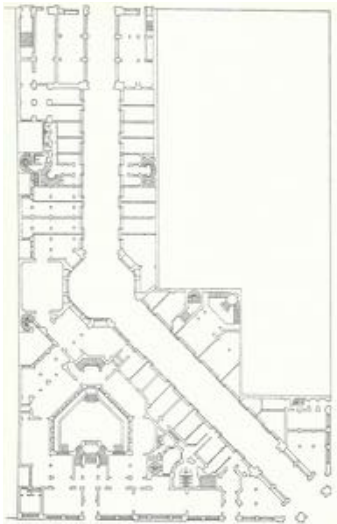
Kaisergalerie; Grundriss, Stand 1909(maßstabslos) (Zeichnung v. J.F. Geist)
